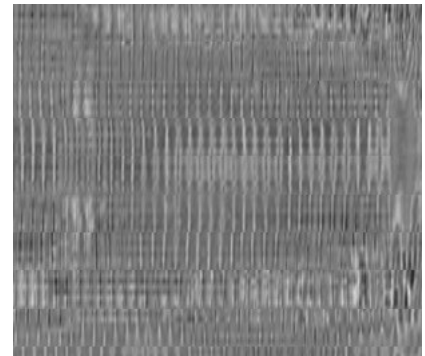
Ricostruzione di una sezione georadar sul piano x-y vista in pianta, alla profondità di 15cm: sono visibili i ferri trasversali di armatura.
